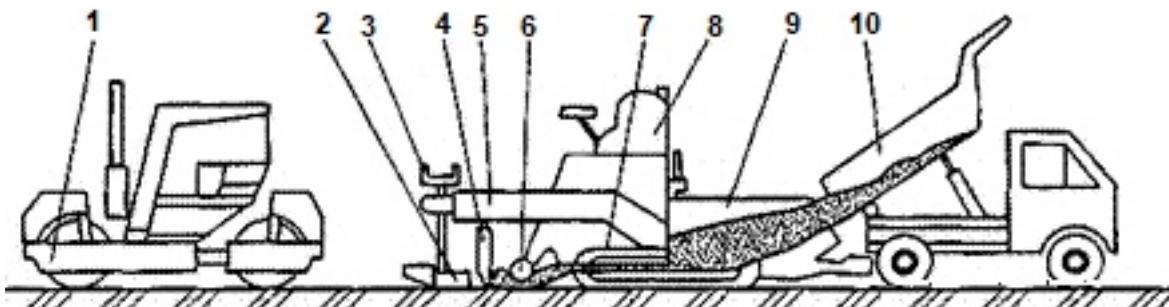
Схема рабочей операции по укладке асфальтобетона
